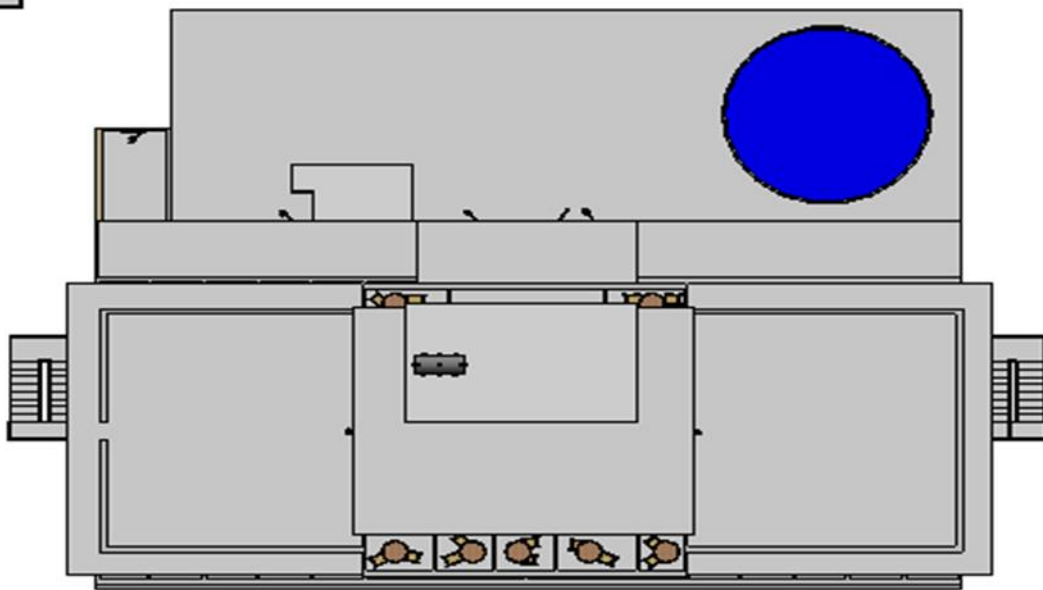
Ilustración IV. Vista en planta del hotel junto a cerramiento exterior con instalaciones de bombeo de la piscina.
